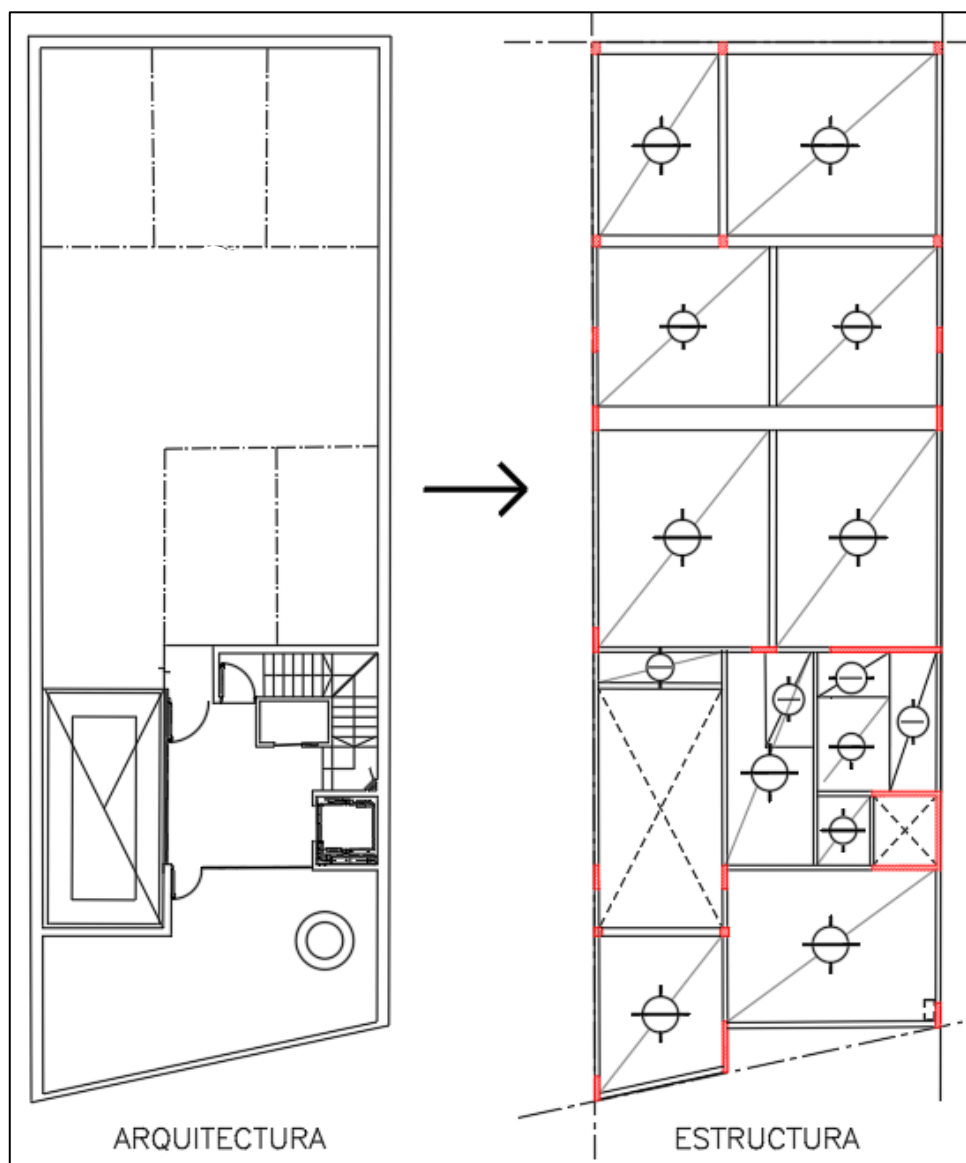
Distribución estructural sobre subsuelo y planta baja.
